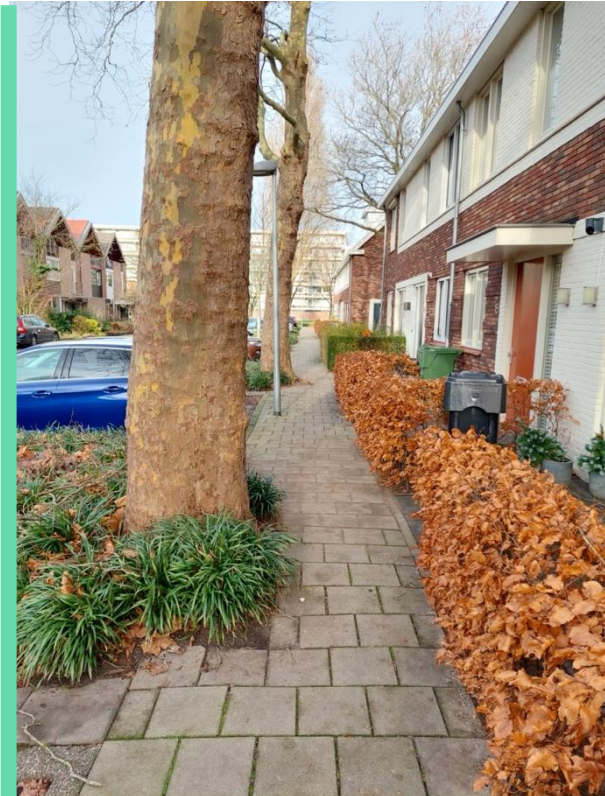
boomnummer 2 & 3, beperkte doorgang
